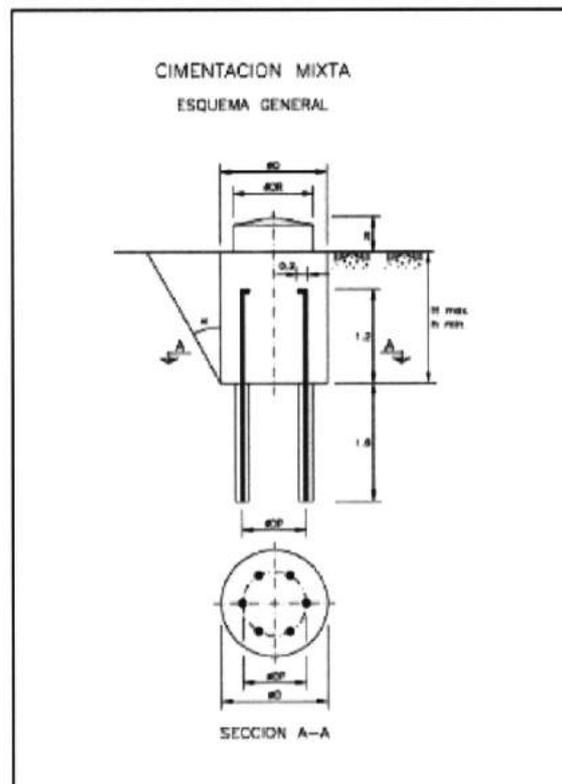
Diseño de cimentación de las torres de celosía tipo concreto en masa
